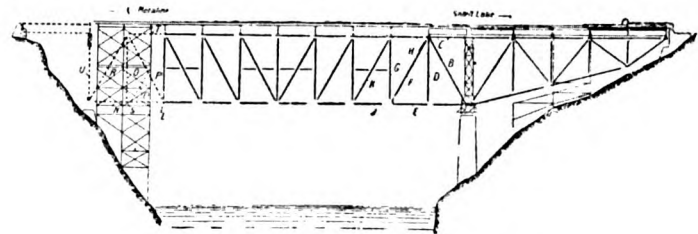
Ponte metallico sul Pend Oreille River. - Elevazione.
